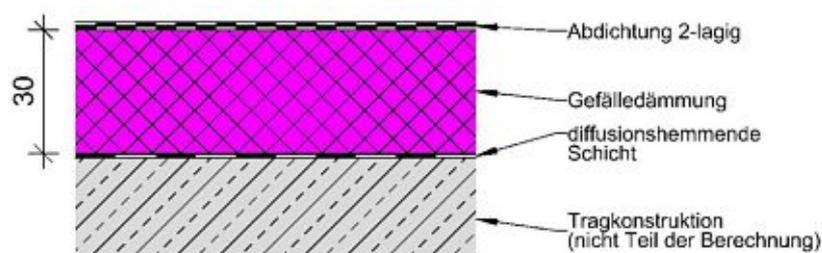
Angenommener Dachaufbau – Foliendach (keine Bekiesung)
